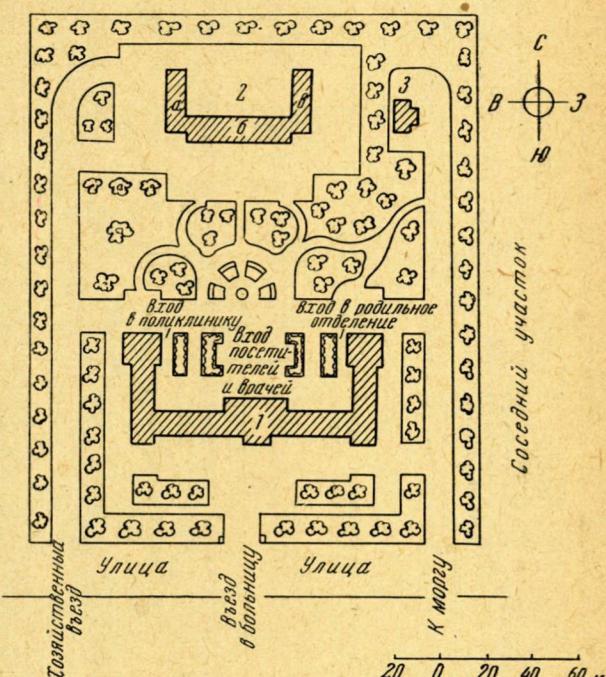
Генеральный план типовой областной больницы на 400 коек (площадь участка 4,38 га).
